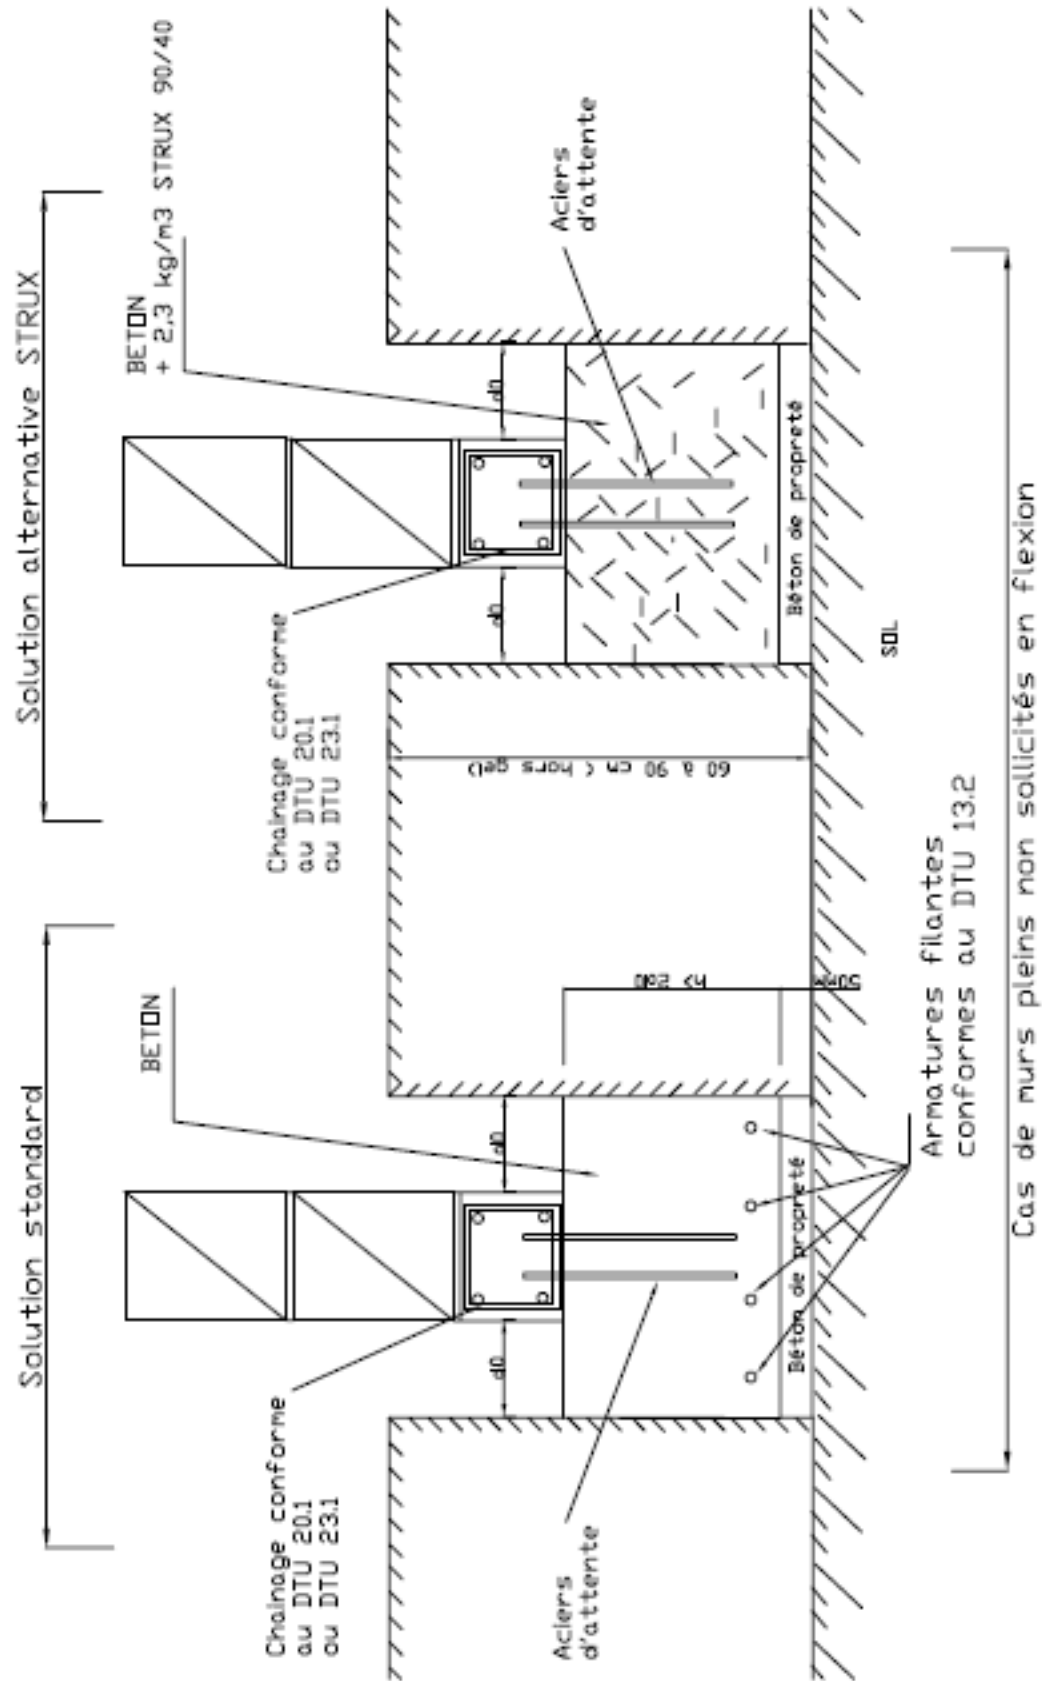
Semelles filantes STRUX® : substitution des armatures filantes
